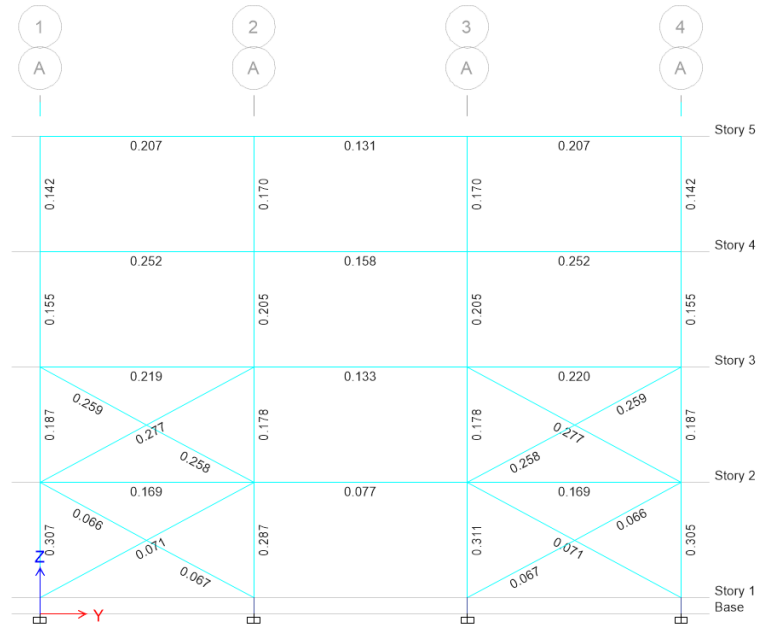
Trabajo de los elementos estructurales sobre eje A, estructura con base flexible, metodología MDOC CFE 2015.
